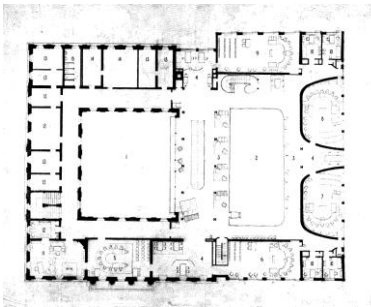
Planta da Câmara de Gotemburgo. Erik G. Asplund
